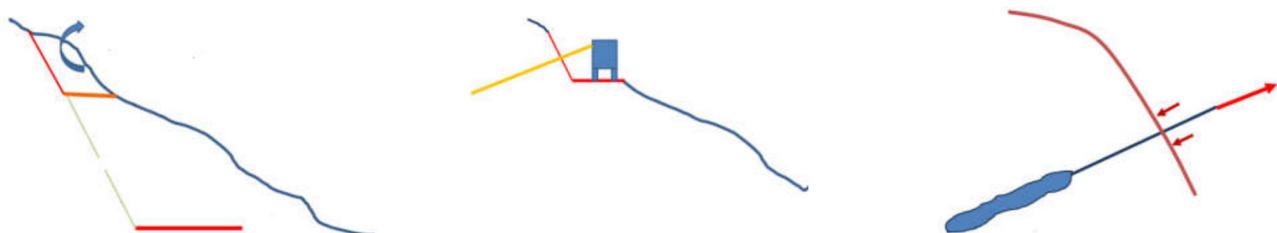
Schéma de la préparation pour l'installation d'un tirant d'ancrage
